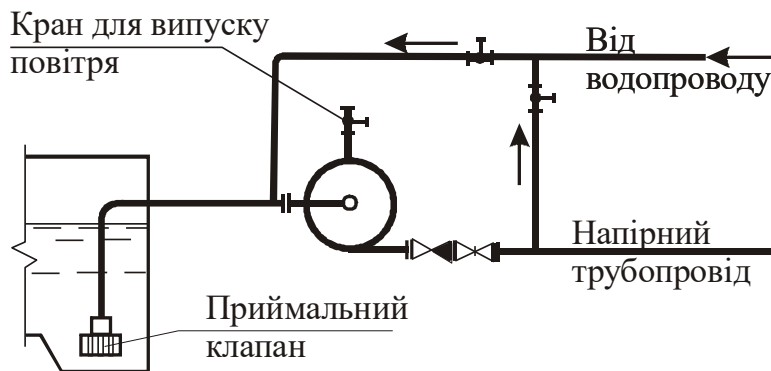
Схема заливання насоса із напірного трубопроводу або від водопроводу
